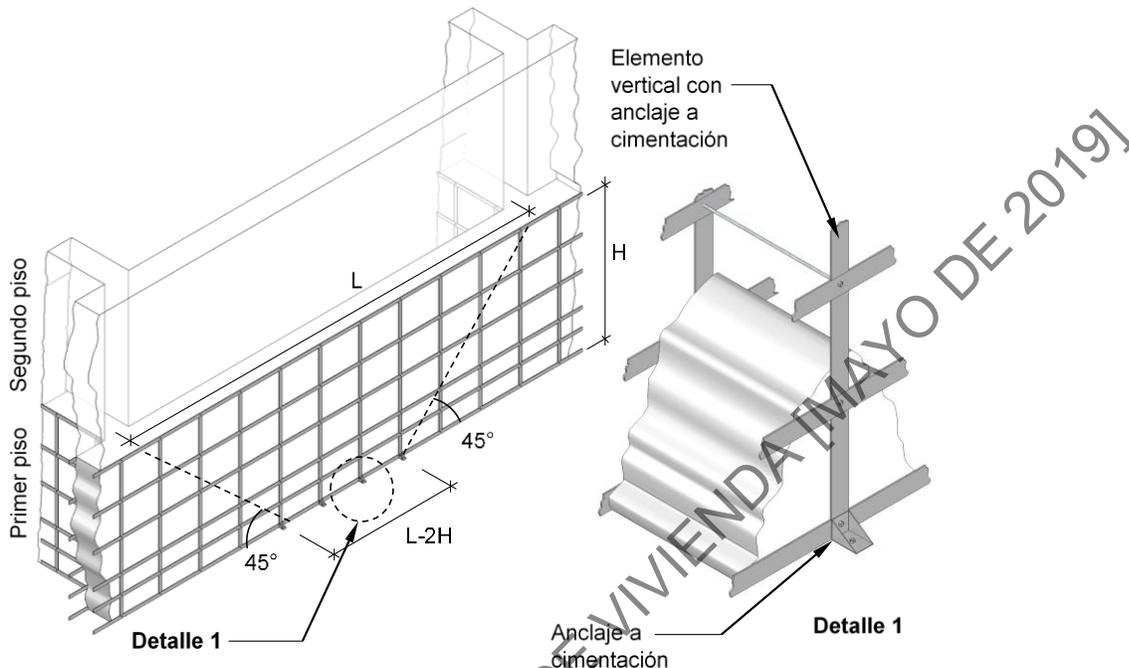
Sistema de anclaje de elementos de refuerzo vertical para entramados de madera, acero, plástico o similar.
